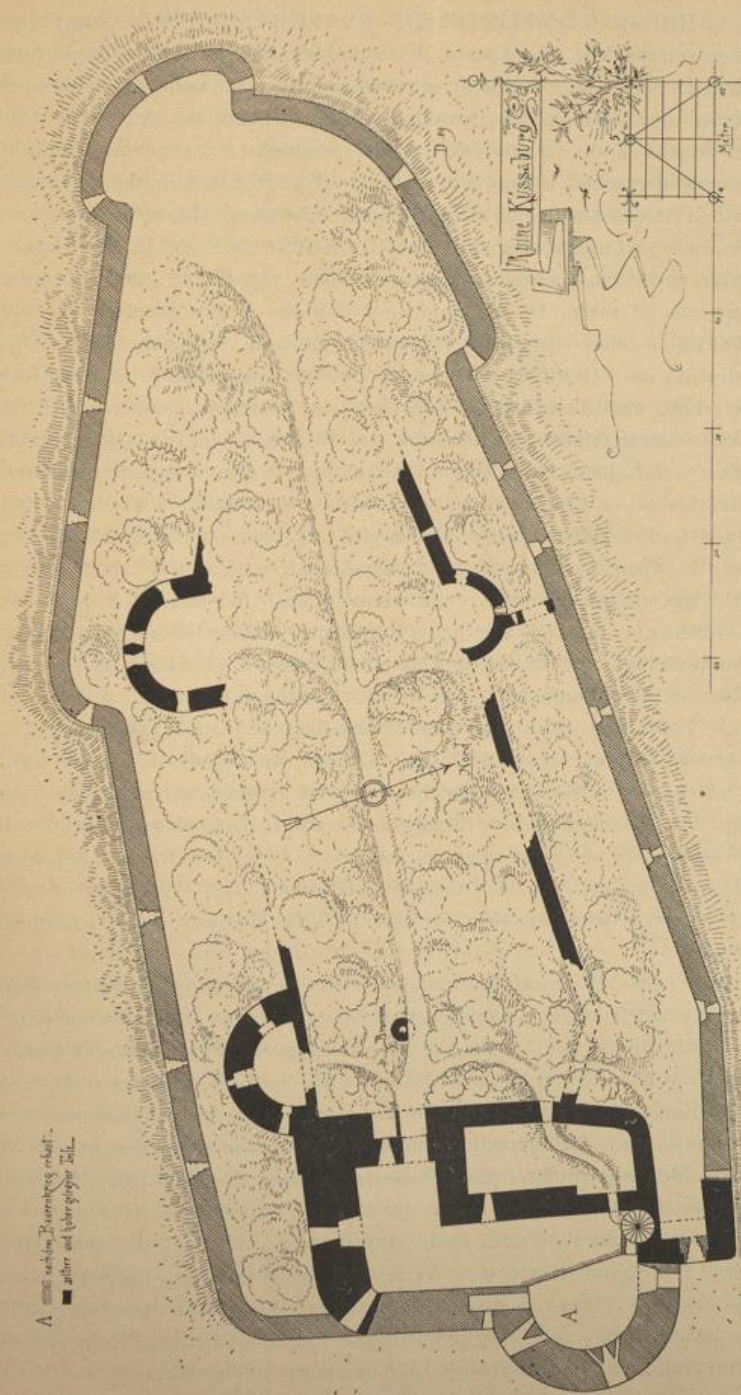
Küssaberg. Grundriss der Burg ruine.
